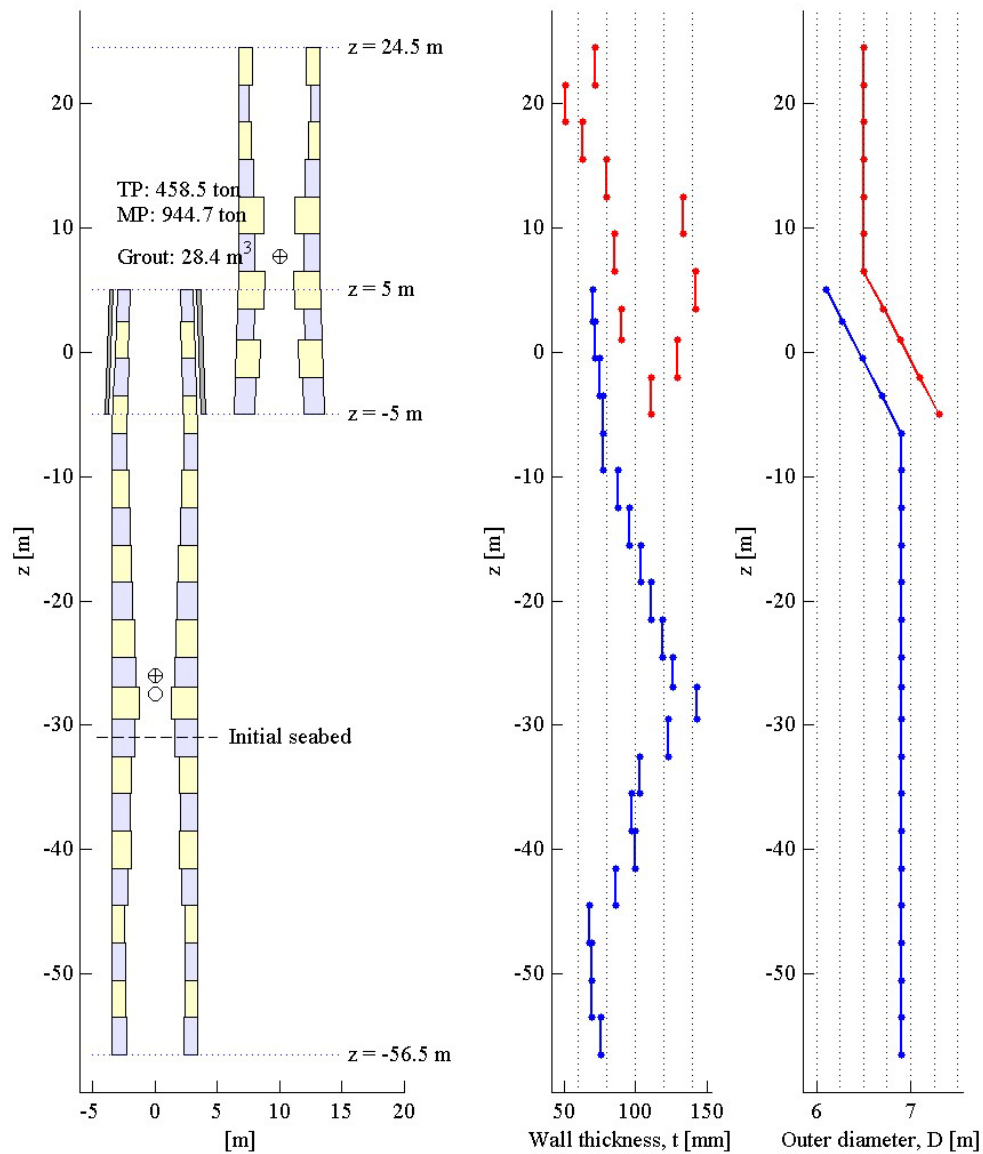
Dimensions d'une fondation pour un positionnement en eau profonde
